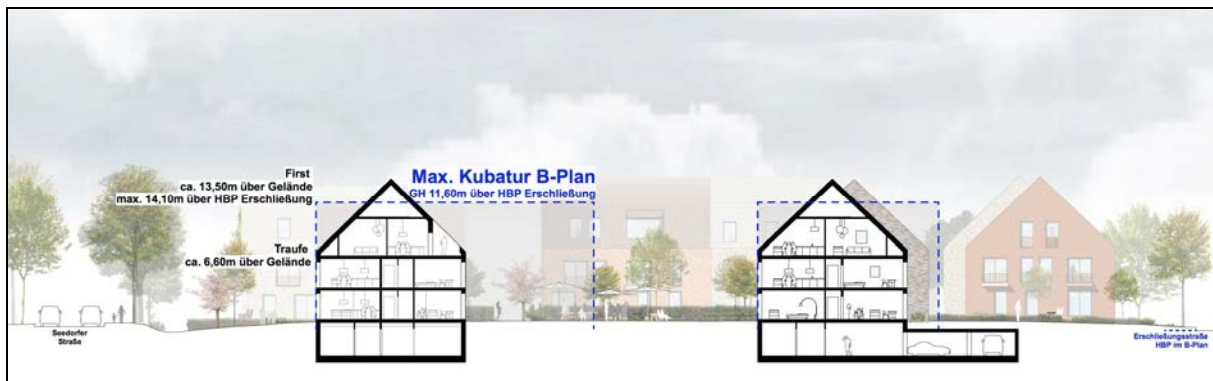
Systemschnitt durch das Baugebiet WA 1 mit Vergleich zu der ursprünglich geplanten Kubatur im B-Plan Nr. 81 (kbnk Architekten Hamburg)
